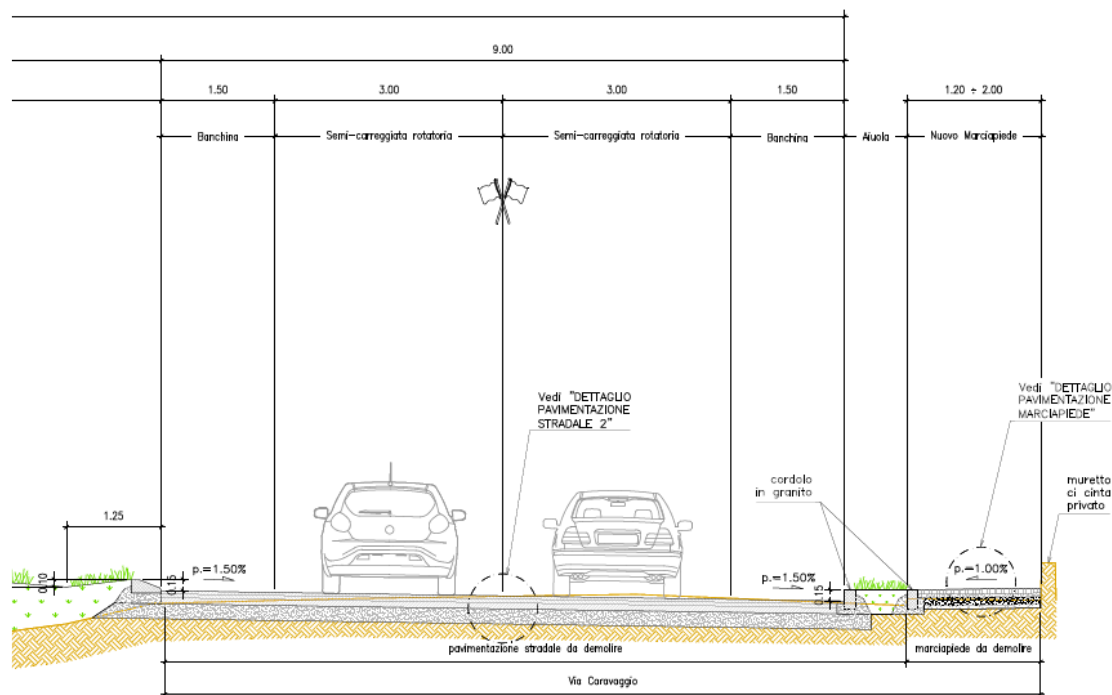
Sezione tipo sulla sede stradale di Via Caravaggio
